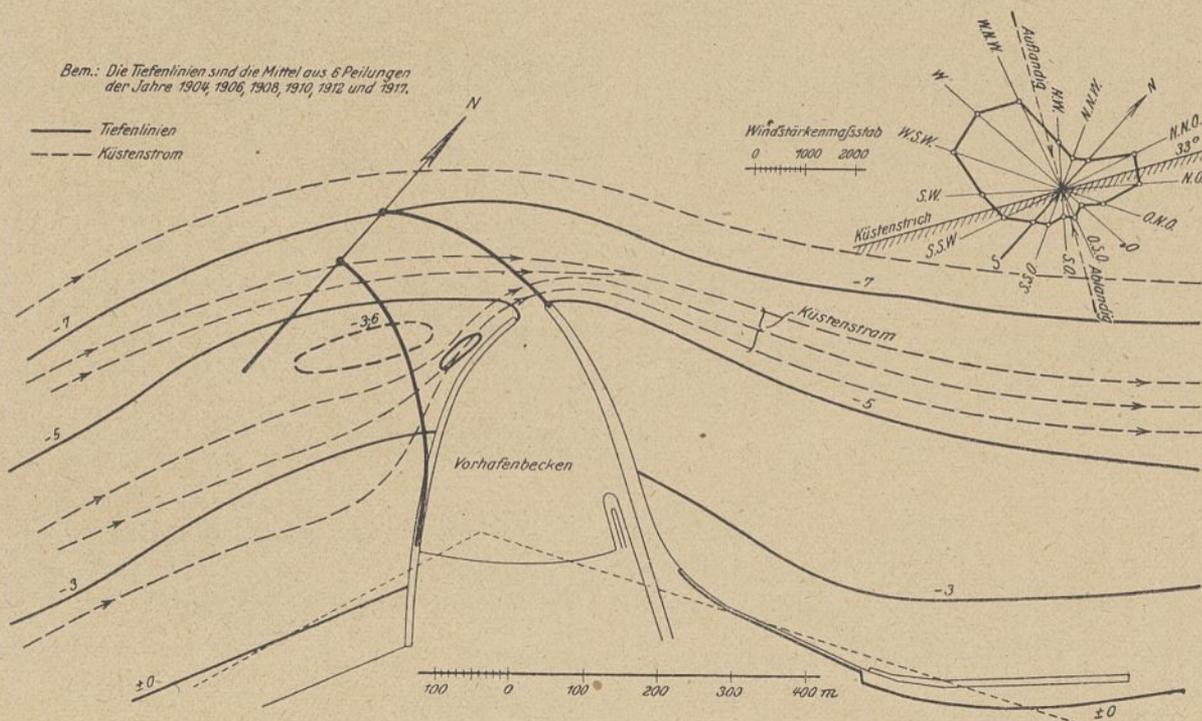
Lageplan des Hafens zu Rügenwaldermünde mit Vorschlägen zur Verlängerung der Molen.
